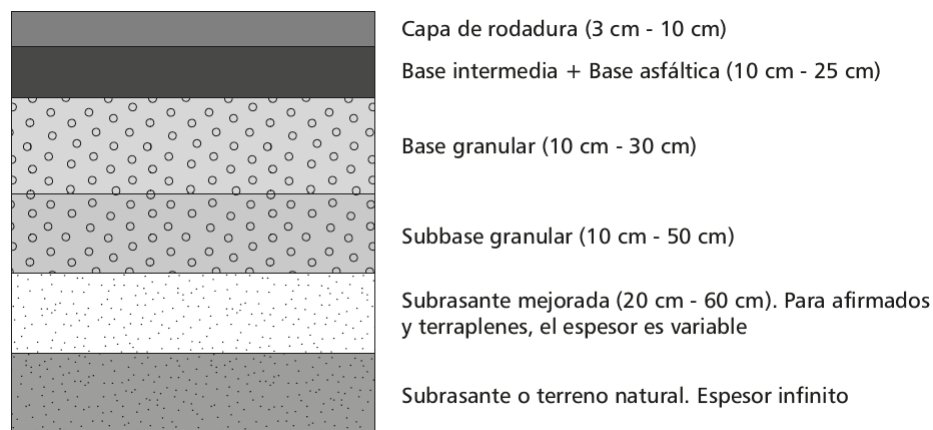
Perfil típico de una estructura de pavimento flexible
